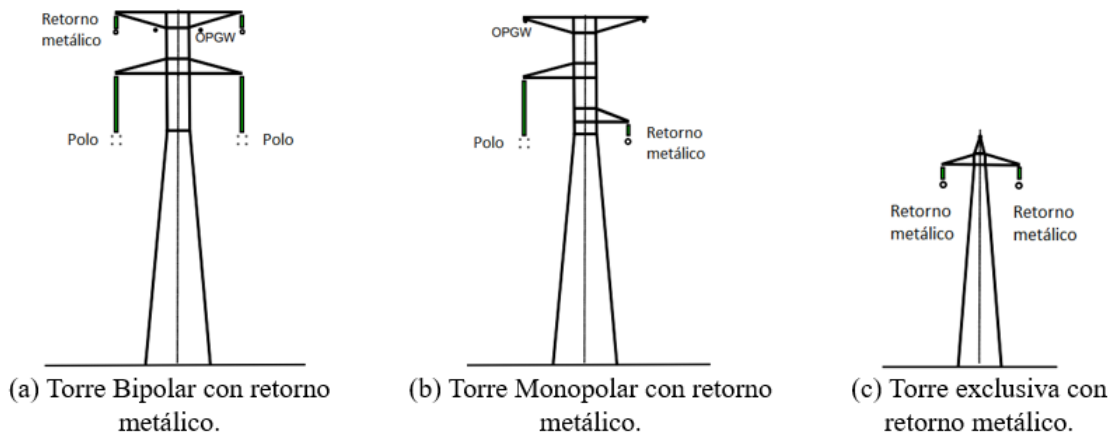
Tipos de estructuras para retorno metálico dedicado.
